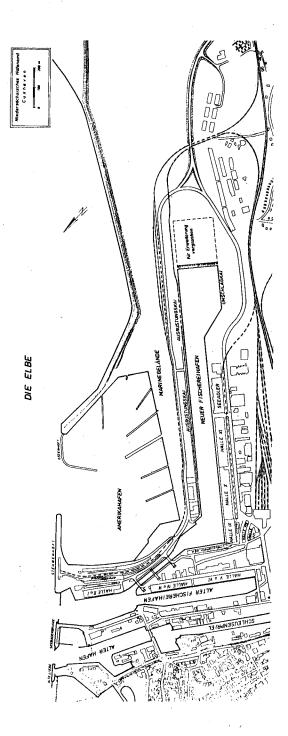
Fischereihafen Cuxhaven, Lageplan mit Schleusen-Neubau
